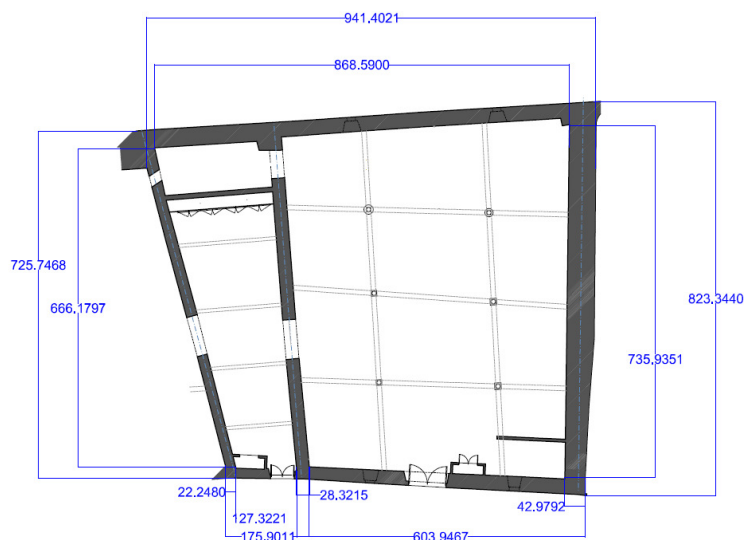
Planta de alvenarias edifícios E04 e E05.
